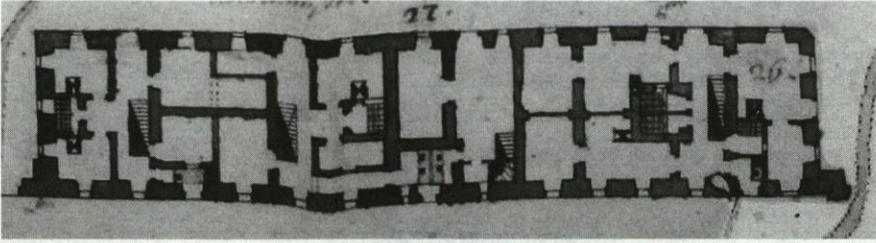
Obermünsterplatz 1-4, Erdgeschoss (Ausschnitt aus dem Münchner Plan, vor 1766).
